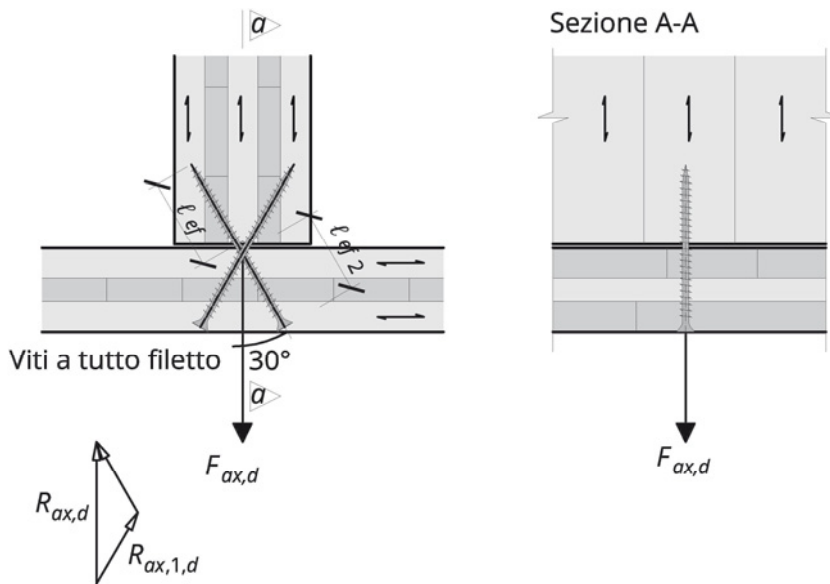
Sospensione tramite viti a tutto filetto inclinate rispetto al piano della parete
